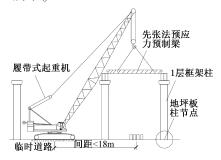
2 层预制梁吊装示意 Fig. 8 Hoisting of 2-layer prefabricated beam
